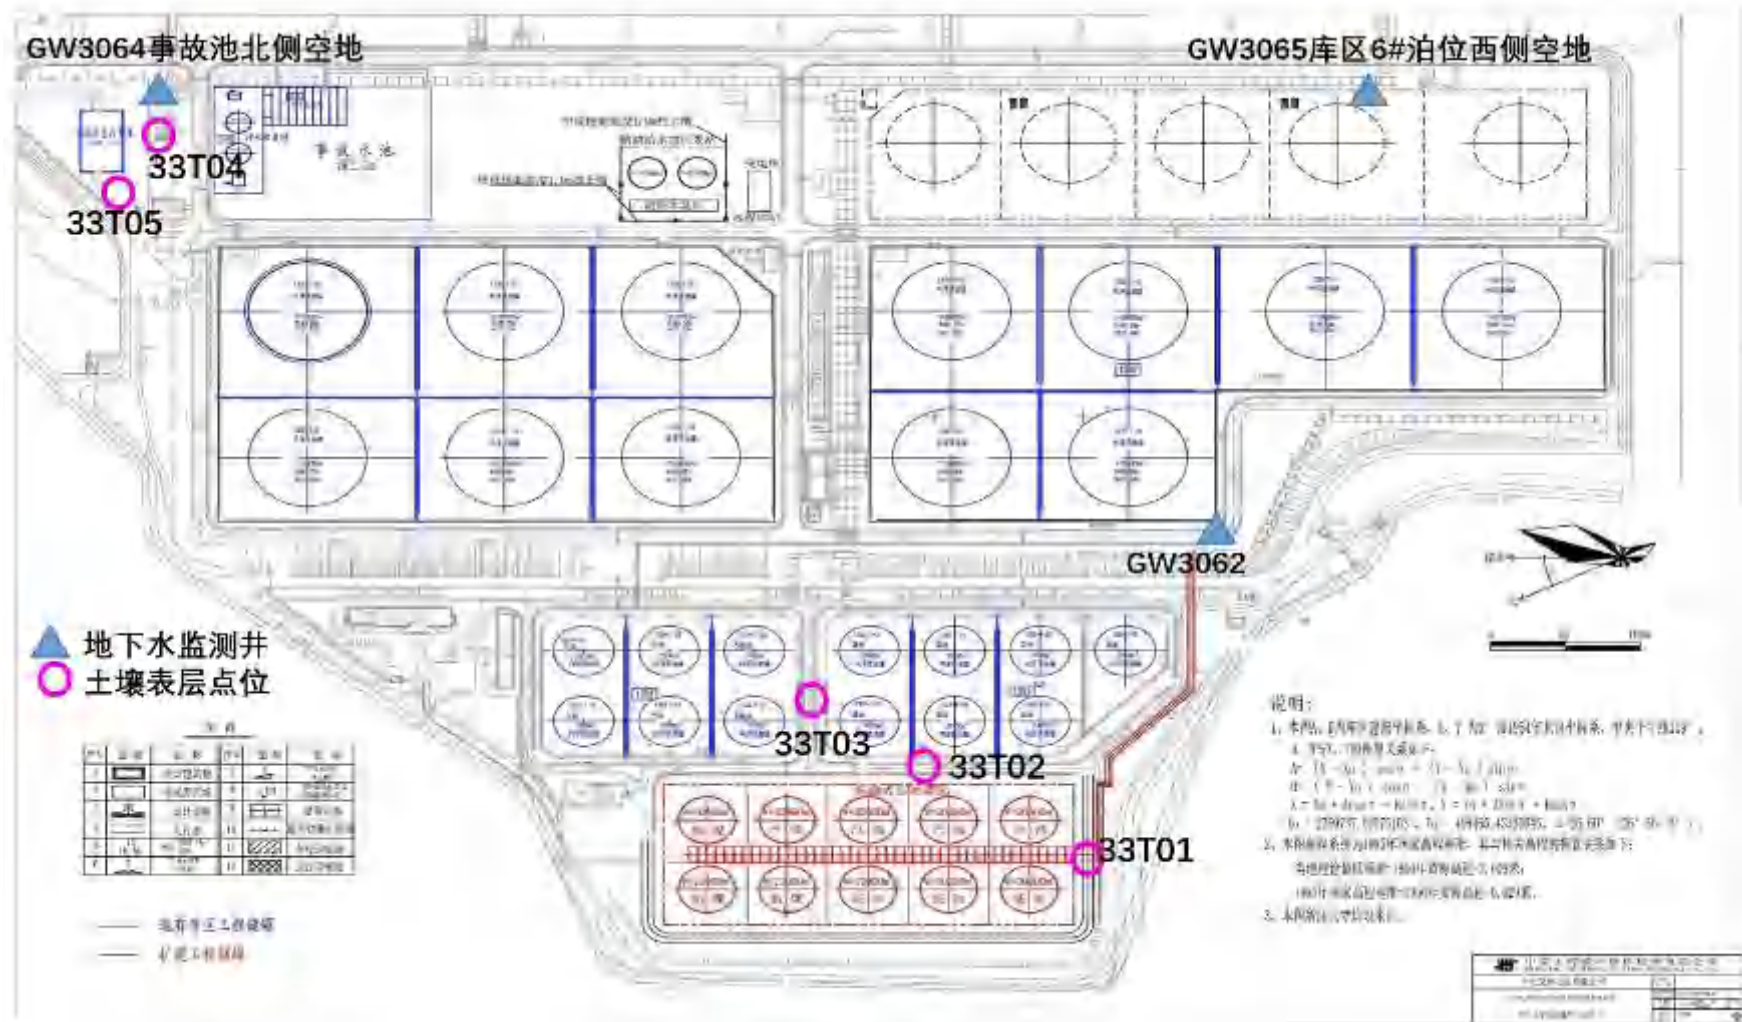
青兰山库区(单元 22) 平面布置及监测点位图
